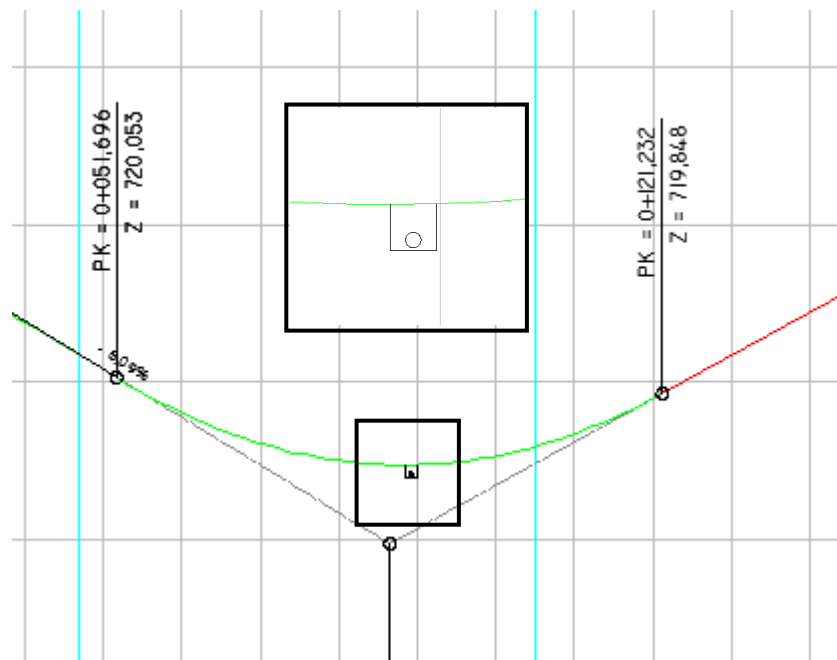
Solução em perfil longitudinal para a drenagem do ramo B
